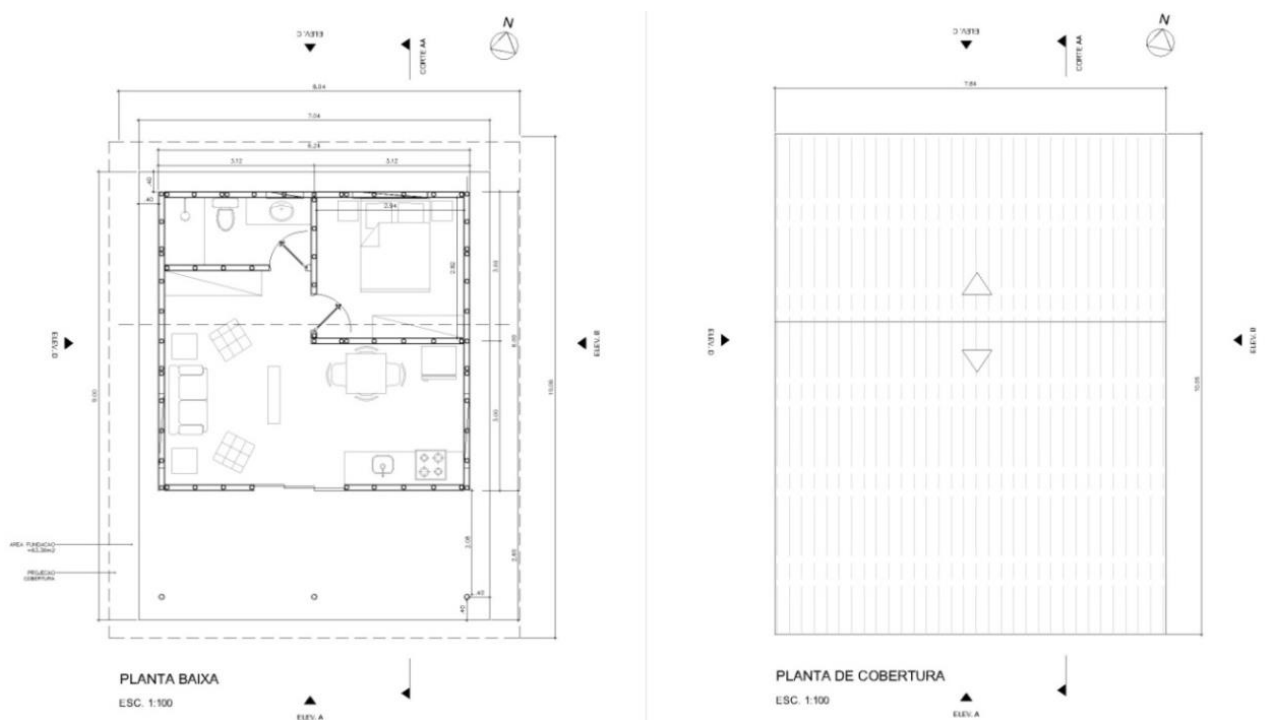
Planta Baixa e Planta de Cobertura do protótipo.
